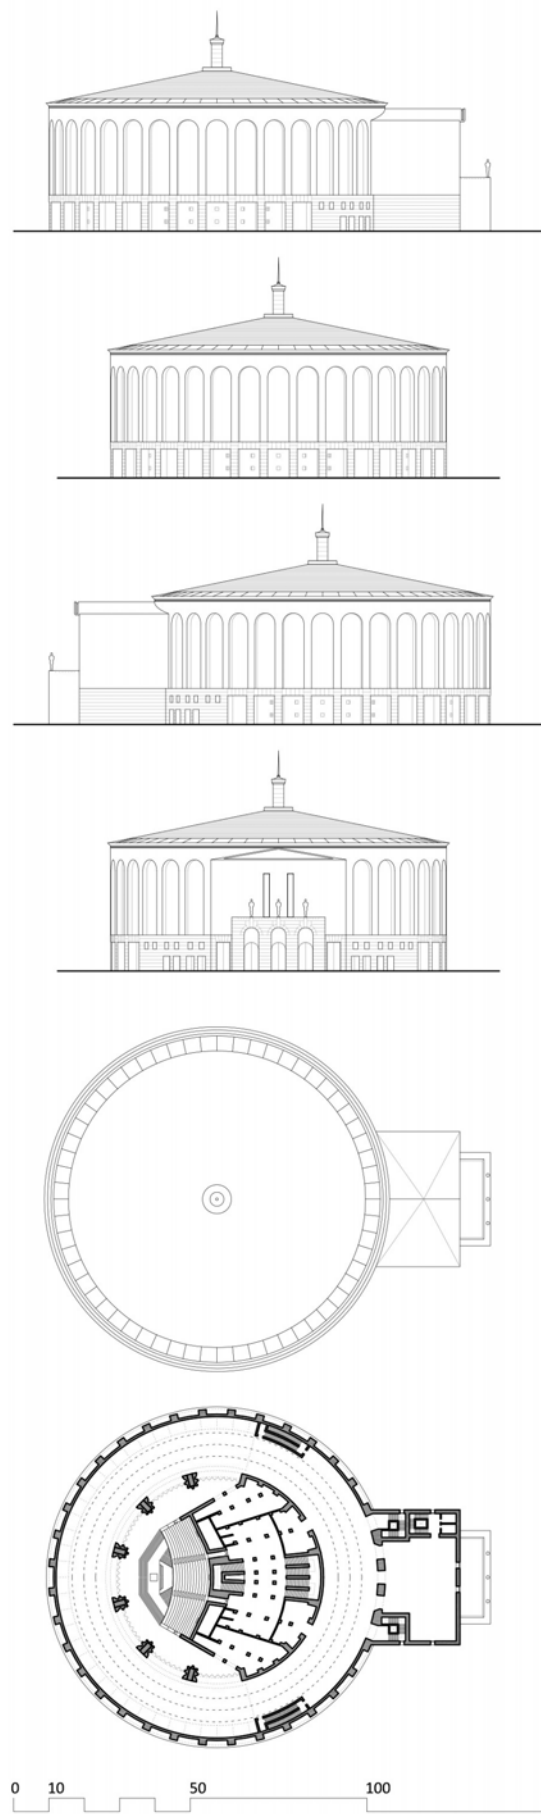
Planimetría del *Ringtheater*. Plantas, alzados y secciones .
